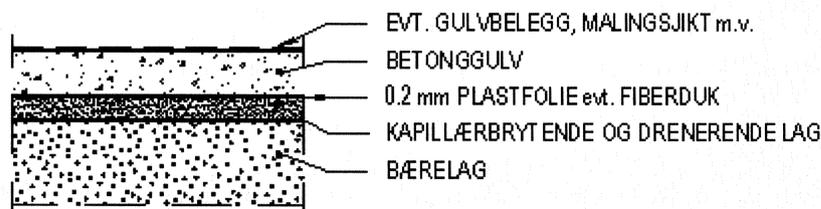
b: Betonggulv, uisolert, på grunnen
